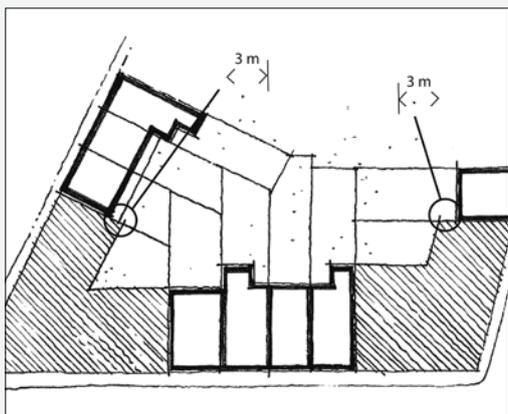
E : profondeur maximale de la construction mitoyenne sur un terrain d'angle (art. 4 § 3).
